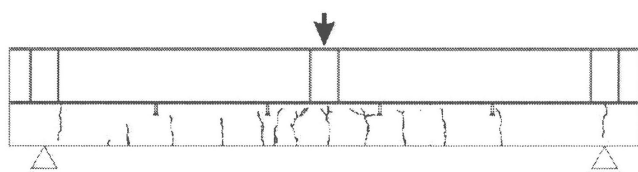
負曲げ試験体のひび割れ状況 (加力終了時, CASE4)
